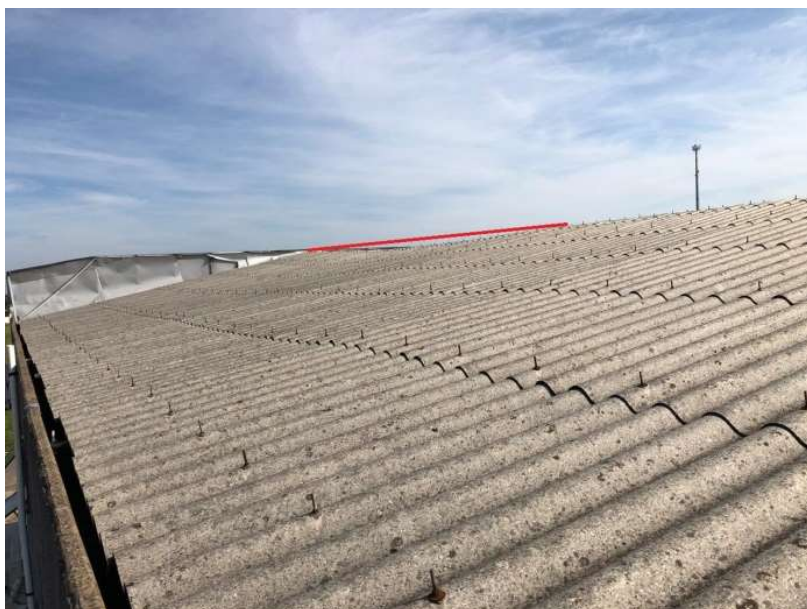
Ponto de flexão de cobertura lado leste ilustrado
